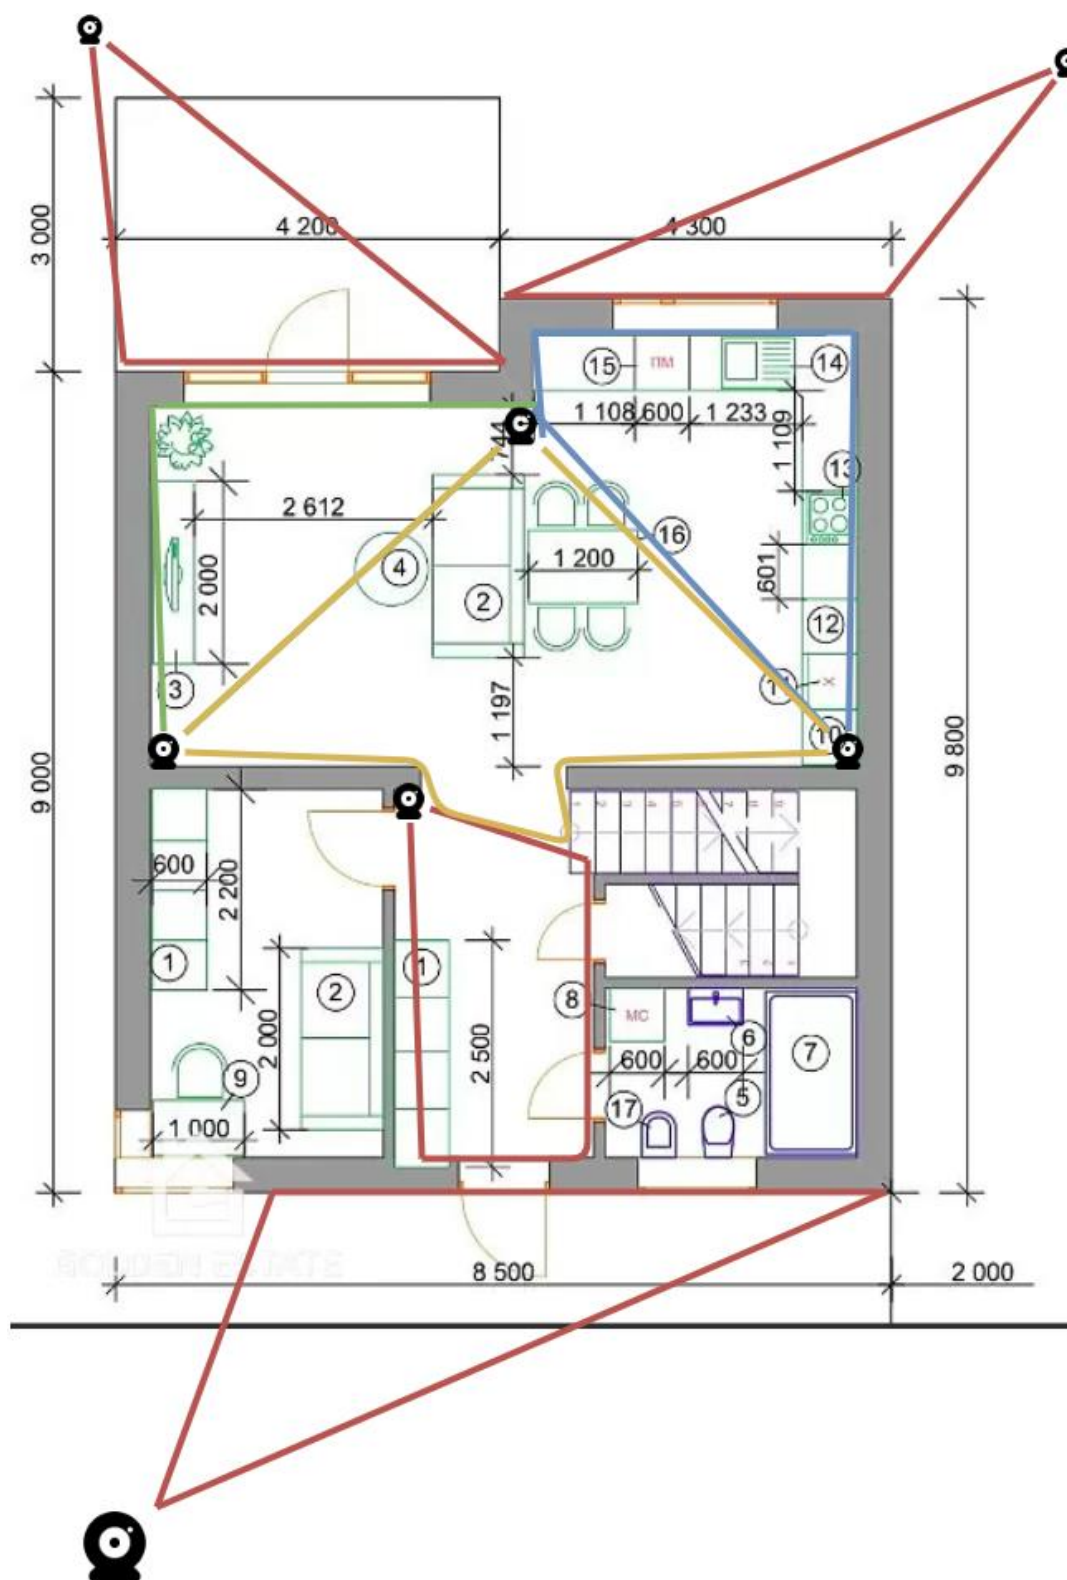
План розташування камер у будівлі (перший поверх)
